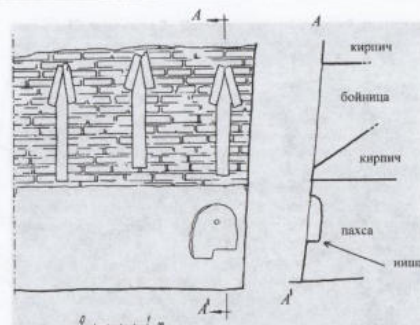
/7. Раскоп 5. Фасад и разрез стены. Вид снаружи
